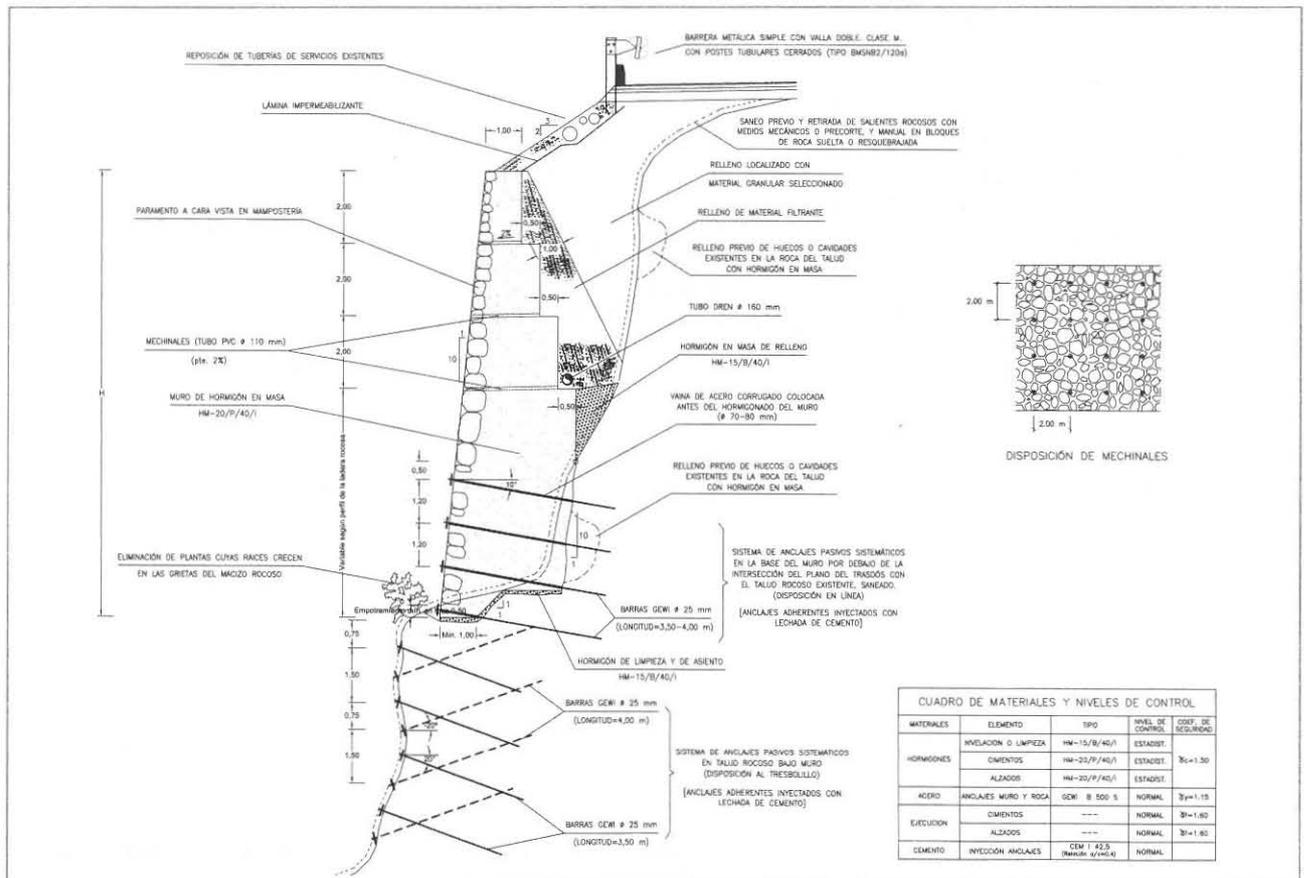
Sección transversal tipo del muro de sostenimiento con anclajes en su base de cimentación y sistema de anclajes para cosido de estabilización del talud rocoso inferior.
